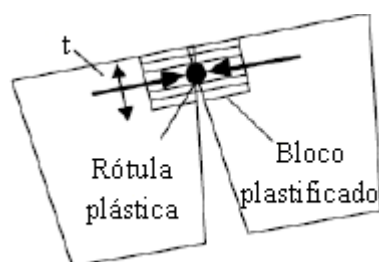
Esquema idealizado de uma rótula plástica formada nas juntas de blocos de alvenaria (adaptado de Sustainable Bridges, 2007)
